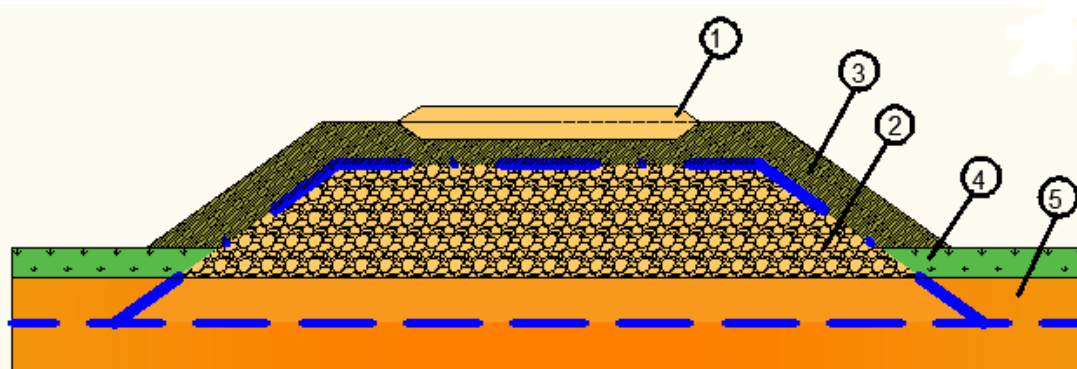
Теплоизоляция грунта насыпи торфом. 1 – крупнообломочный грунт; 2 – слой мерзлого слабого глинистого грунта; 3 – слой торфа; 4 – мохорастительный слой; 5 – естественный грунт основания.
